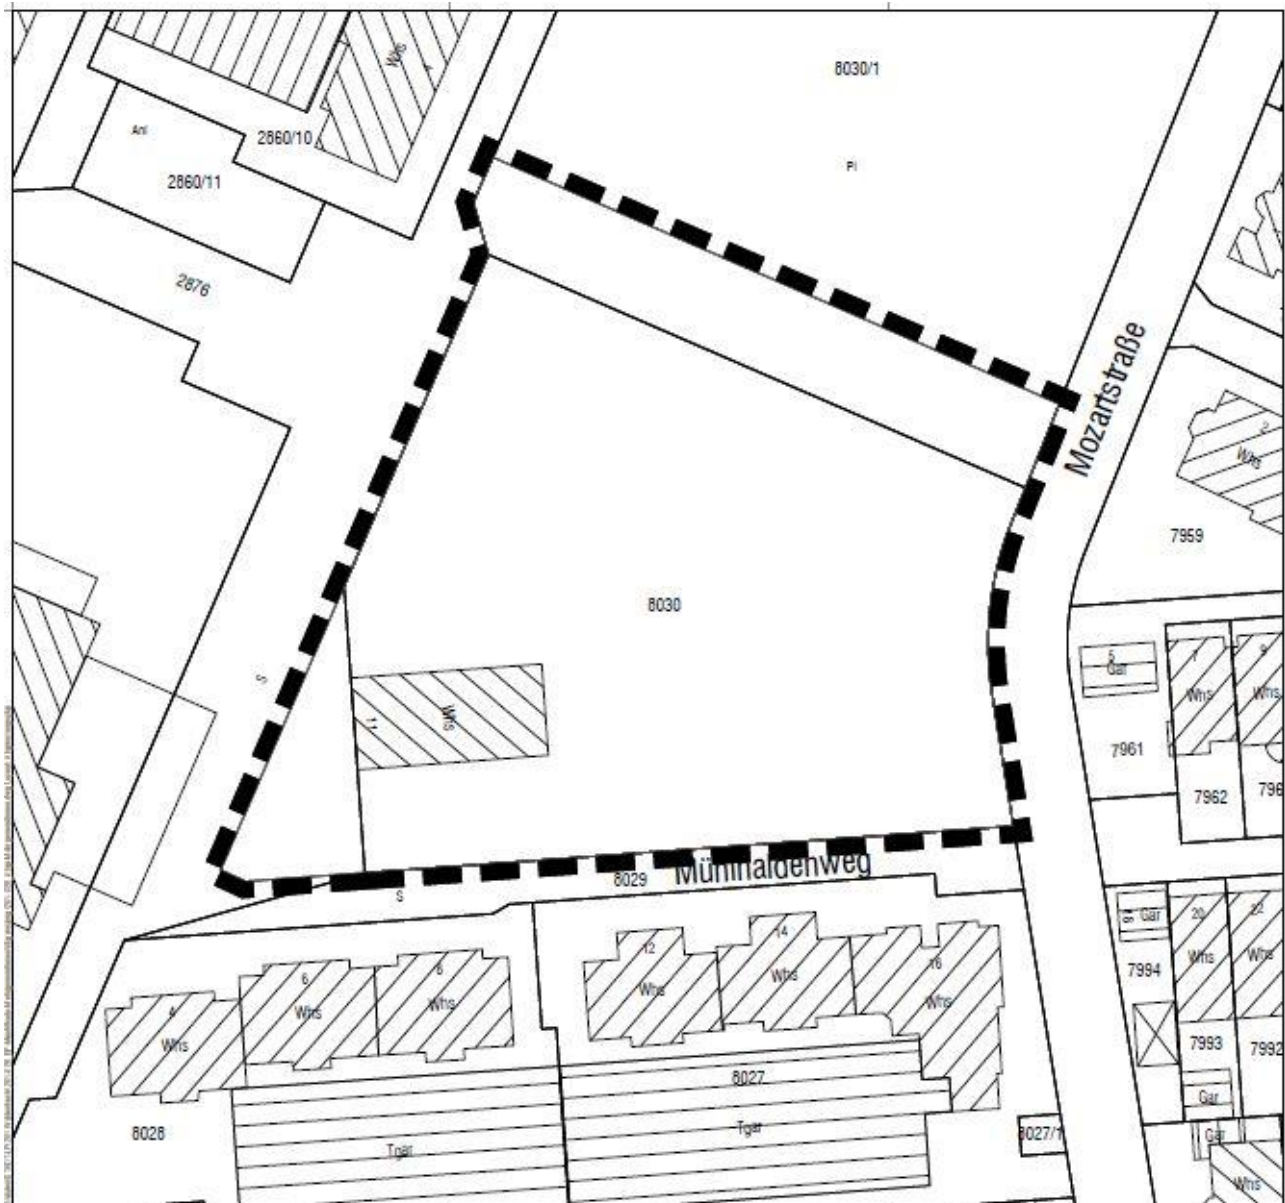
Lageplan überplanbare Fläche (BALDAUF ARCHITEKTEN UND STADTPLANER GMBH 2018)
